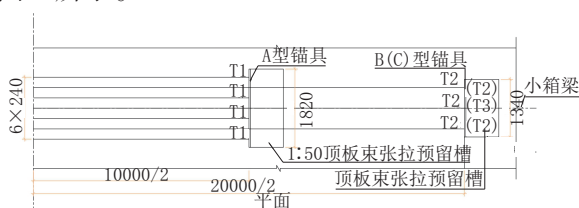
小箱梁张拉槽口优化设计平面图(单位:mm)
